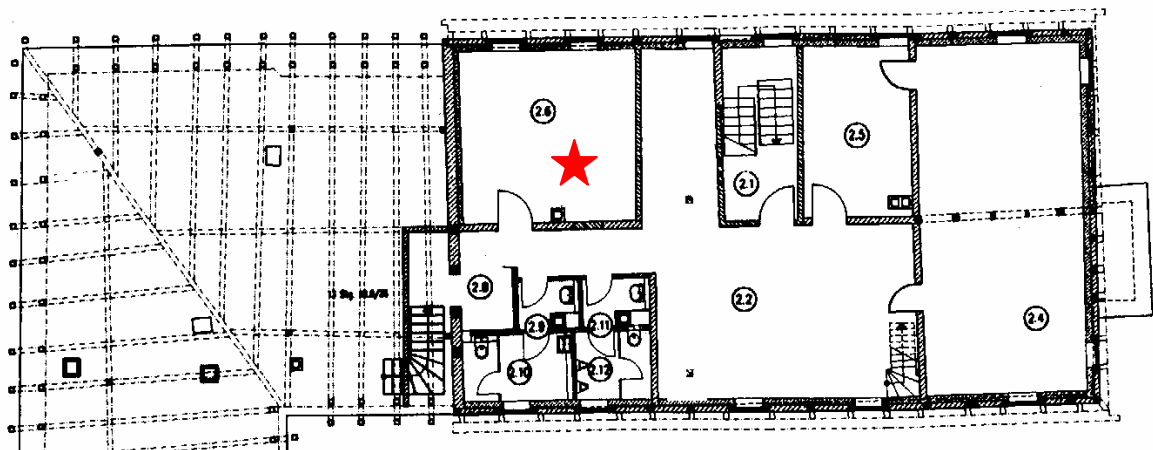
Grundriss 2.Obergeschoss
